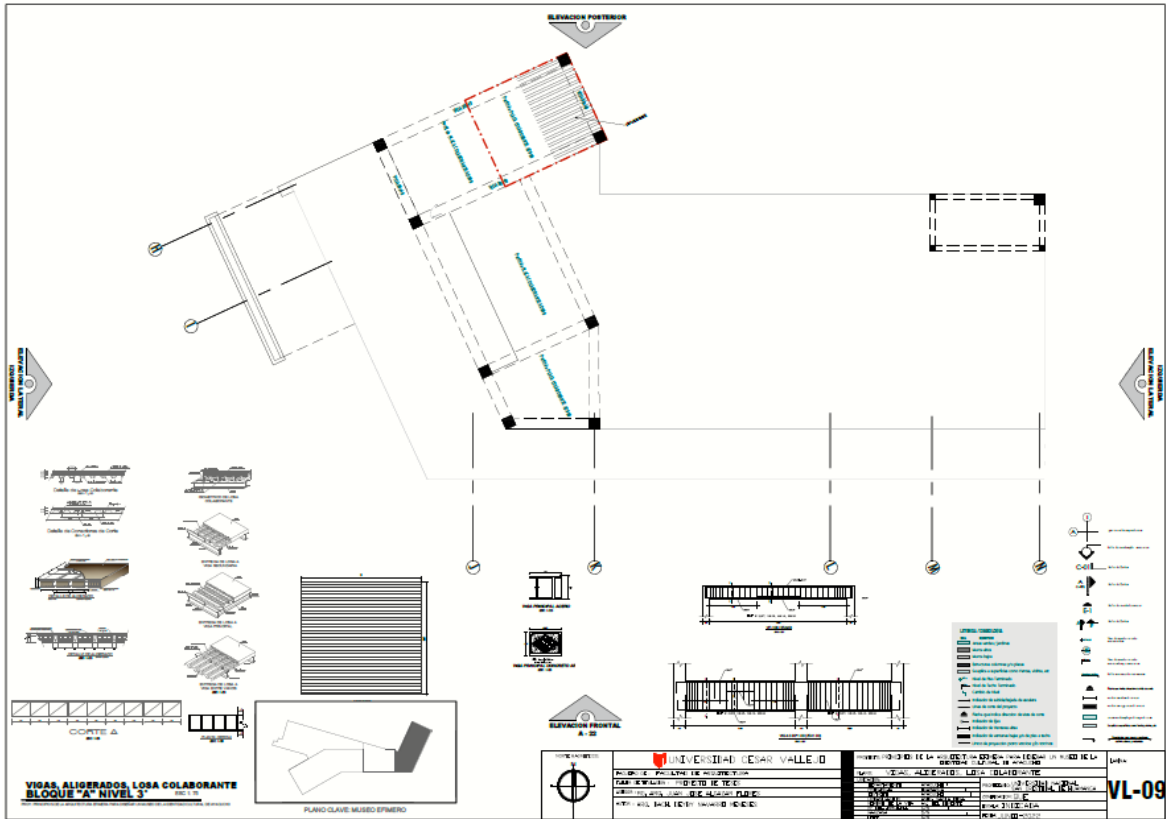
Plano de Vigas y Losas bloque B tercer nivel
